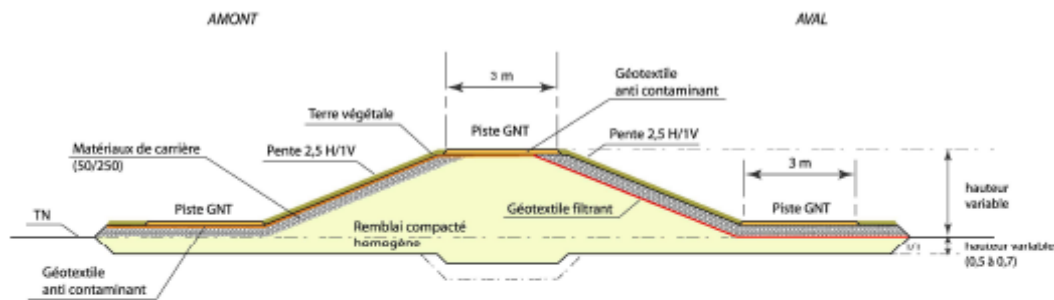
coupe de dige de protection de Saleilles et du bras creux
